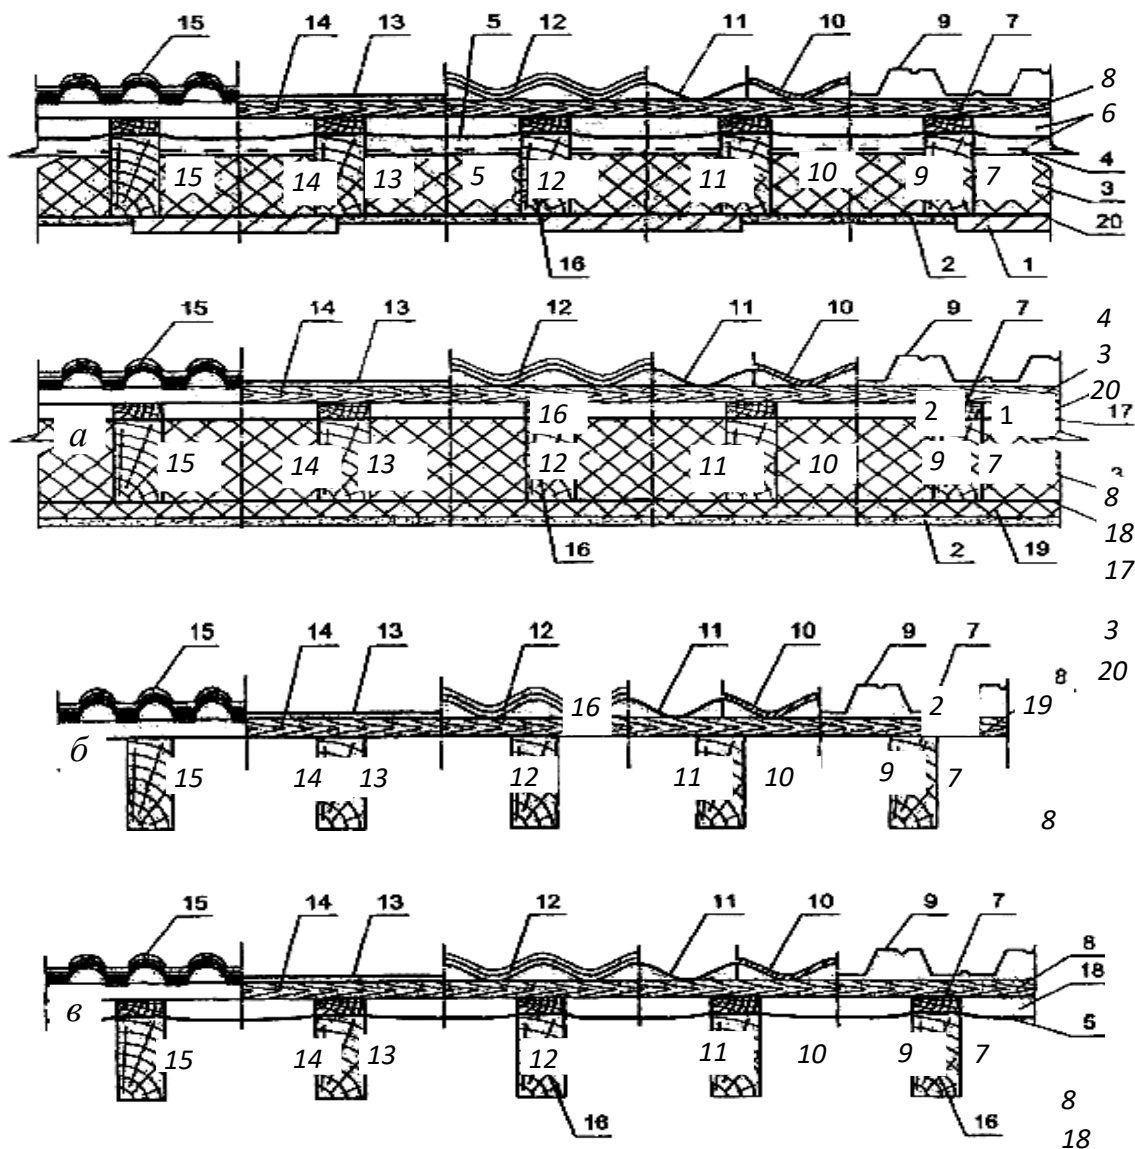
Конструктивні рішення покрівель похилих покриттів: 5 а, б – тепле; в, г – холодне; 1 – плита опорядження стелі; 2 – гіпсокартон; 3 – теплоізоляція; 4 – вітрозахисний бар'єр; 5 – дифузійно-гідроізоляційна плівка; 6 – двоканальний вентиляційний зазор; 7 – контрлата; 8 – лата; 9 – профнастил; 10 – хвилястий лист з азбестоцементу; 11 – хвилястий бітумний лист; 12 – металочерепиця; 13 – м'які бітумні плитки; 14 – настил; 15 – цементно-піщана черепиця; 16 – кроквина; 17 – вітрозахисна дифузійно-гідроізоляційна плівка; 18 – одноканальний вентиляційний зазор; 19 – теплоізоляція; 20 – пароізоляція
